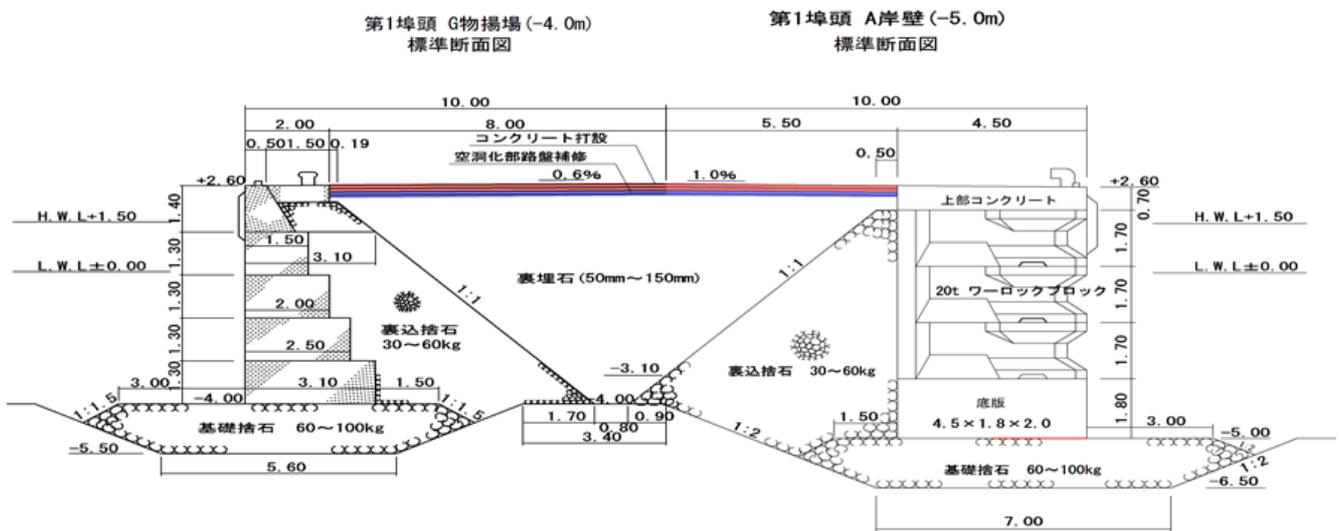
No.28 大洗港区_第1埠頭地区 A岸壁の断面図 (復旧後)
